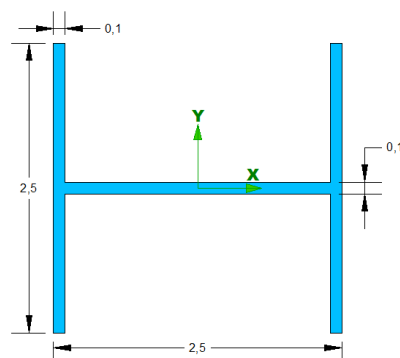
Dimensiones reales en planta del muro de concreto armado de forma “H”
